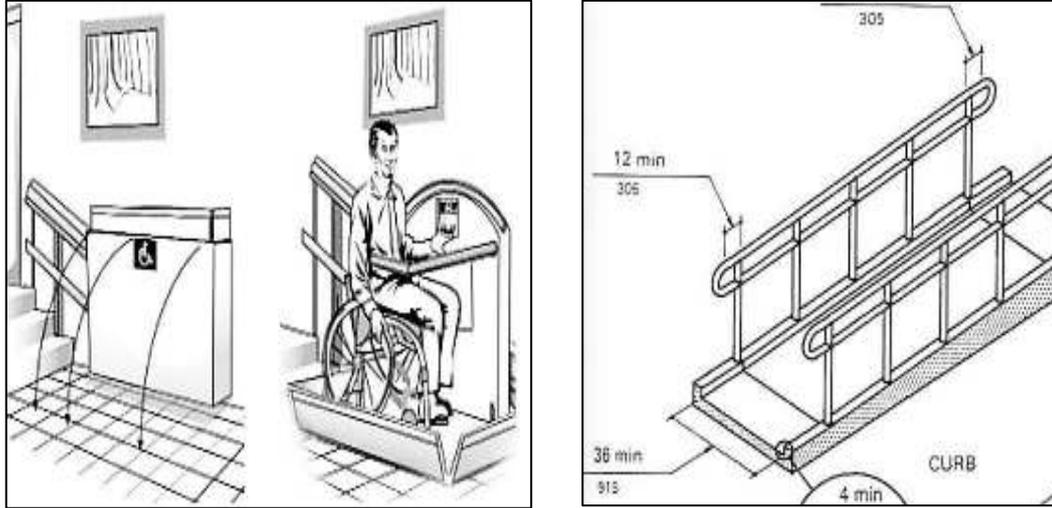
مسقط أفقي وقطاع طولي بمنحدر
